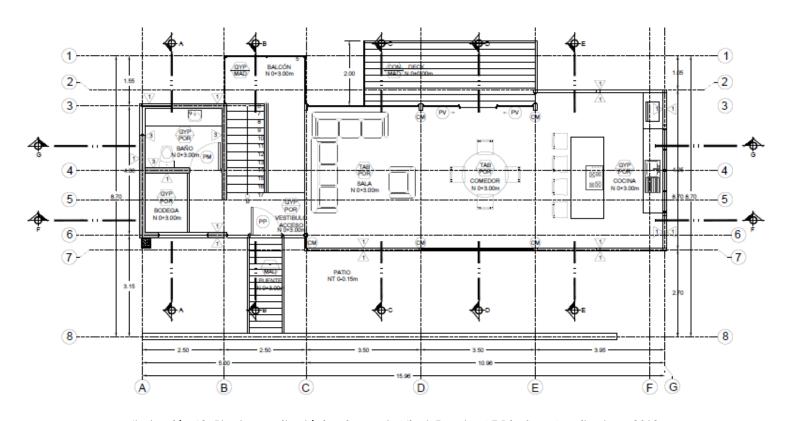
Planta arquitectónica Segundo Nivel. Fuente: AE Diseño y Arquitectura, 2019.
